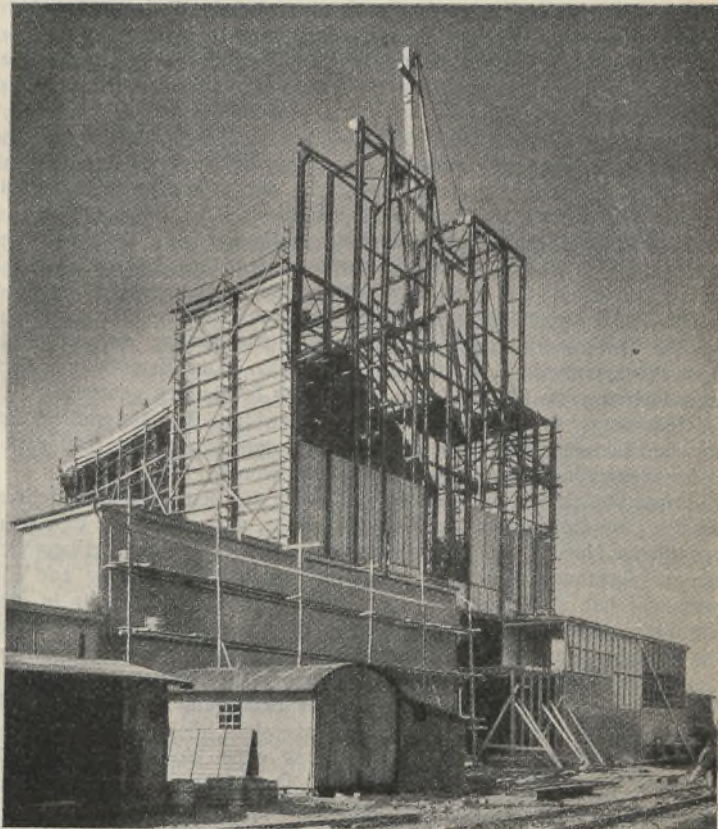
Zusammenbau des Turmgerüsts. Bauzustand Ende April 1928.
